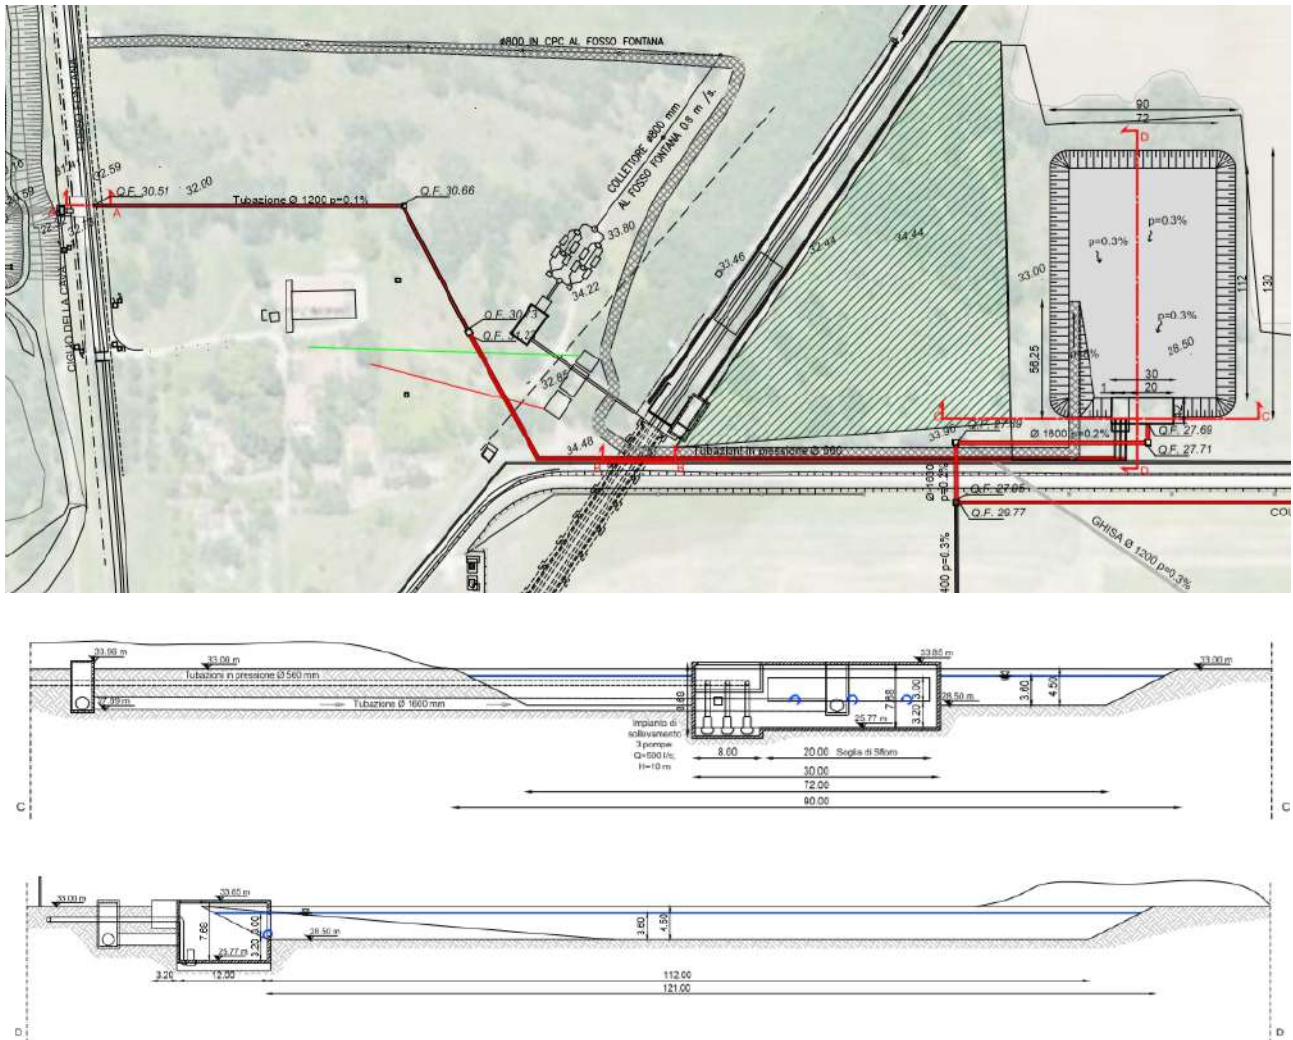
Planimetria e sezioni della versione 3 della vasca di laminazione
